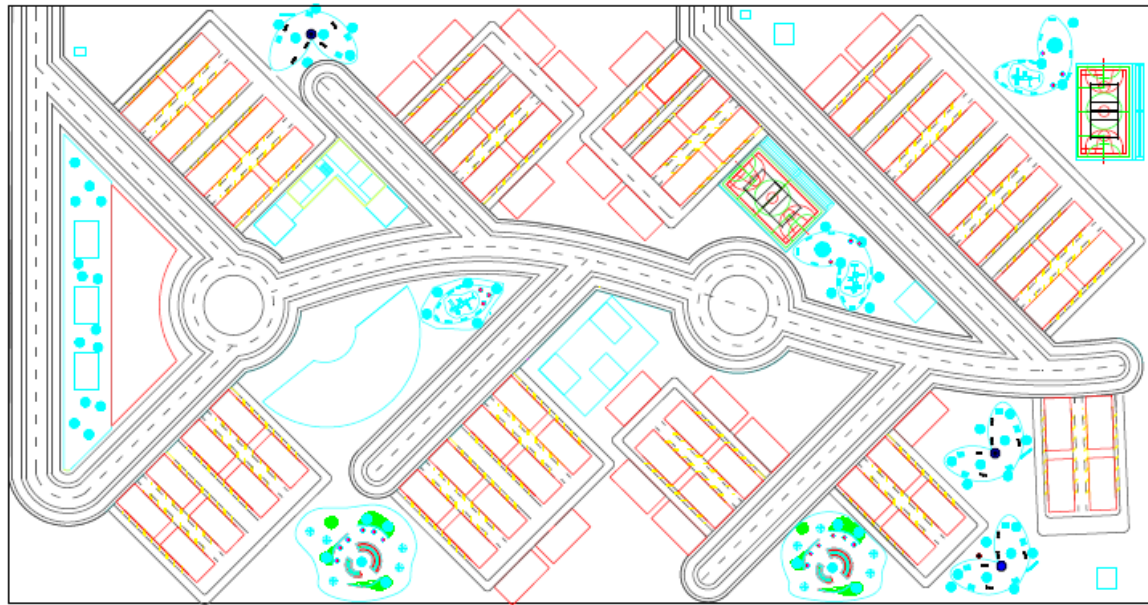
Vista de la Planta Arquitectónica del Proyecto.
